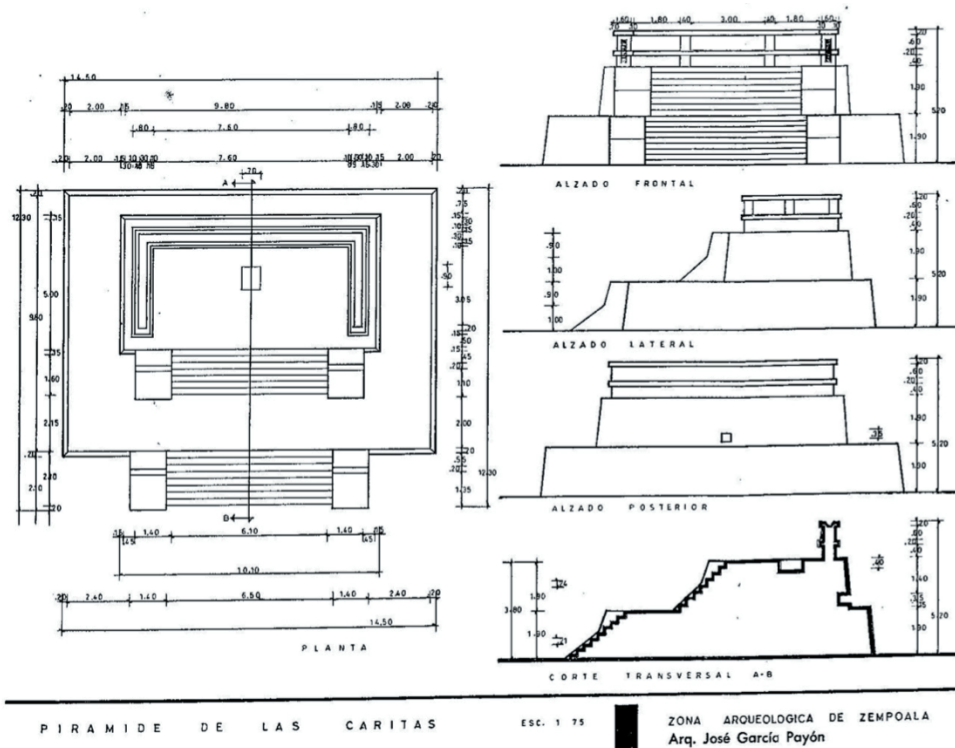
Planta y perfiles del Templo de las Caritas elaborado por el Arquitecto José García Payón.
